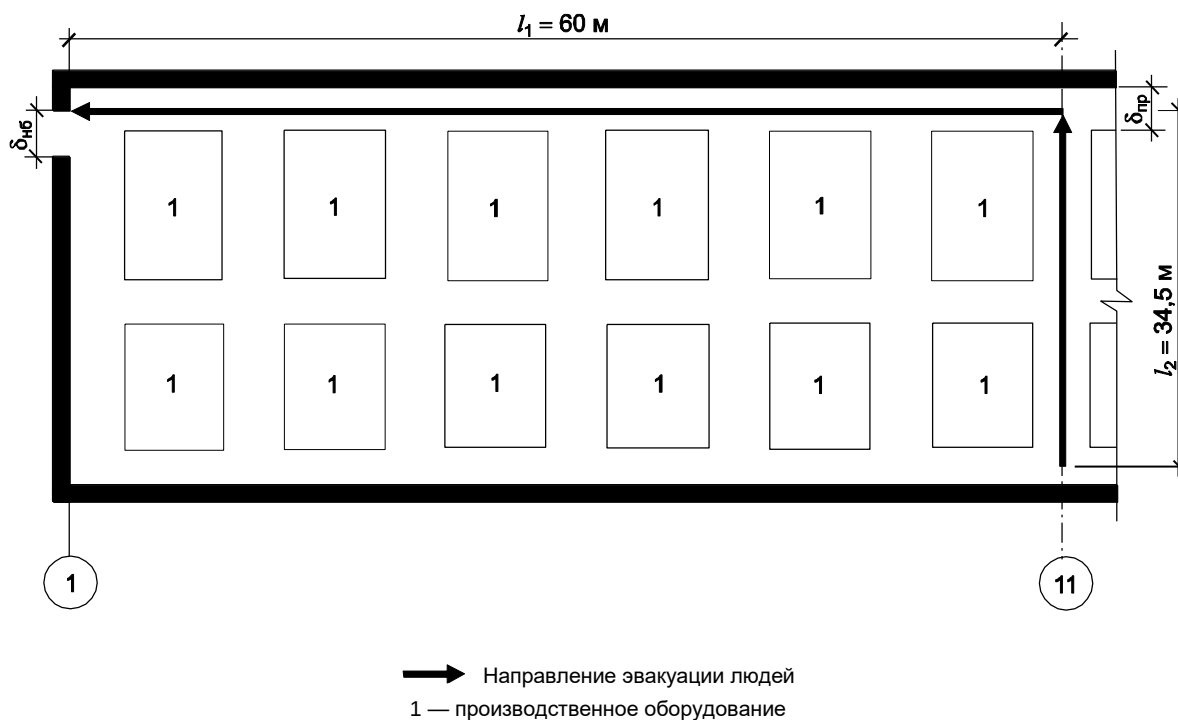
Фрагмент схемы помещения (этажа)
